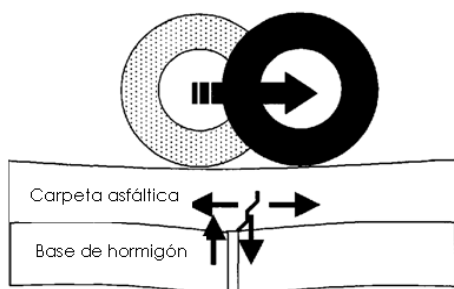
Mecanismo de fisuración del pavimento Figura 3. Falla por mala adherencia entre capas
